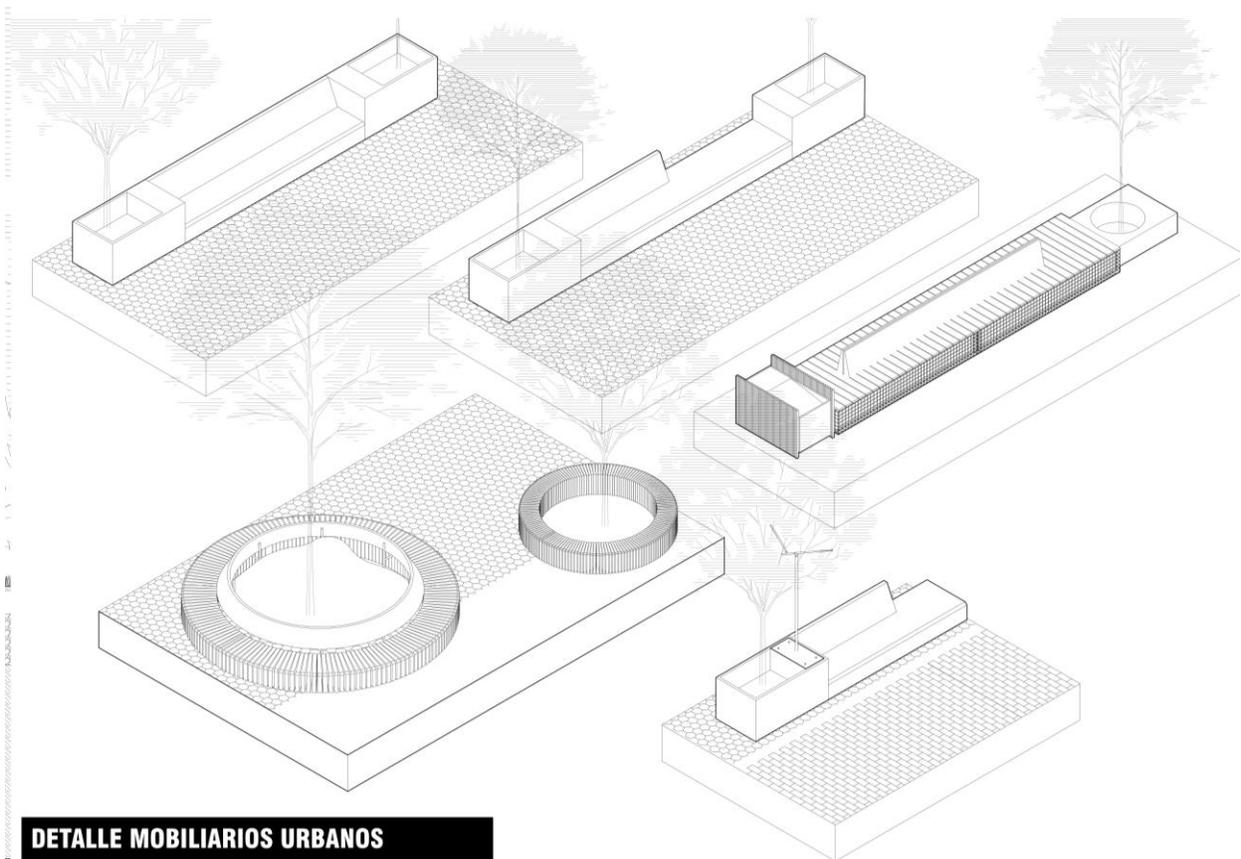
Vista – Detalles Constructivos. Fuente Propia.
